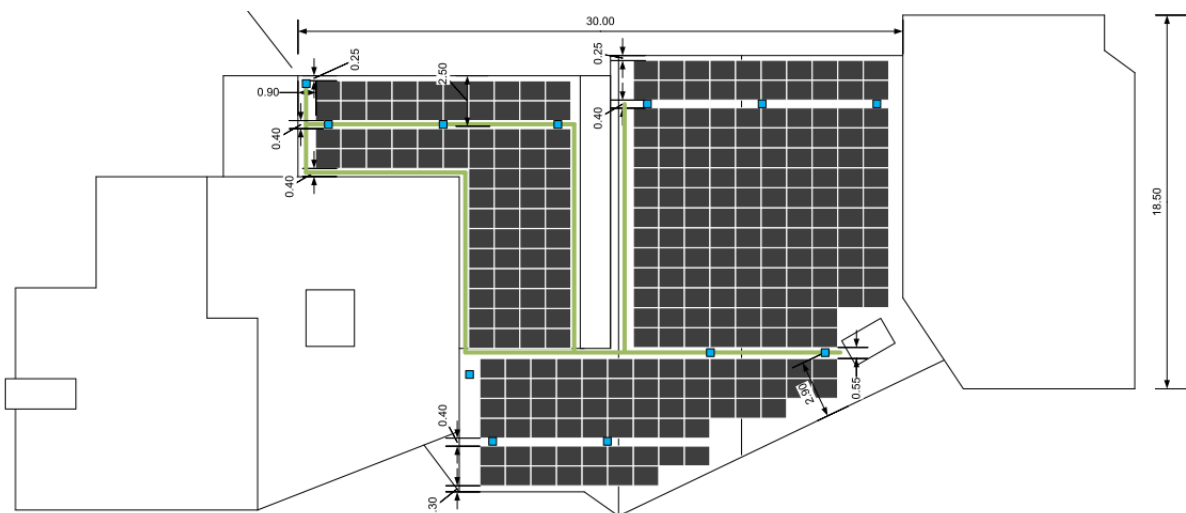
Dachlayout der geplanten PV-Anlage mit Absturzsicherungen und Durchgängen (akt. Planungsstand)
